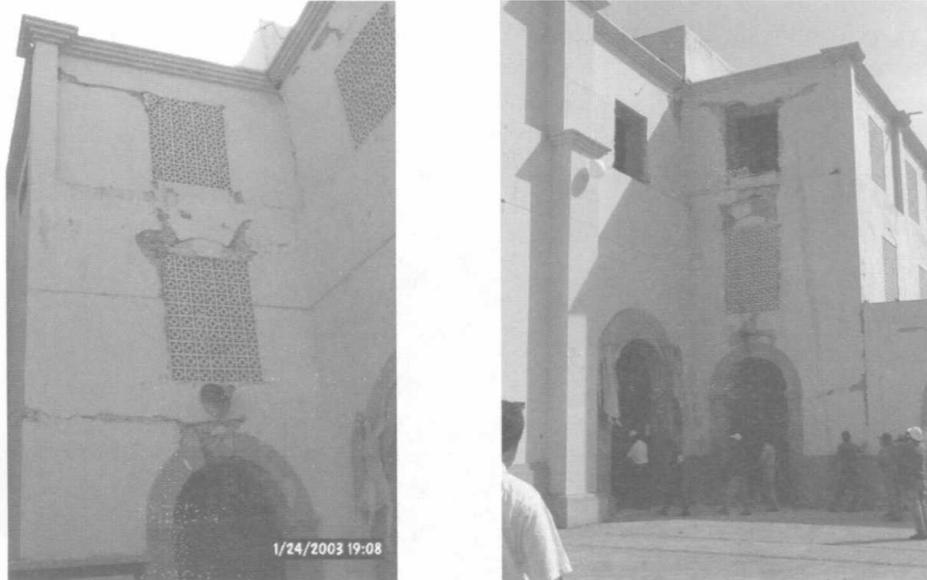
Patrones de daño en los muros de mampostería en el crucero, lado Norte y Sur
